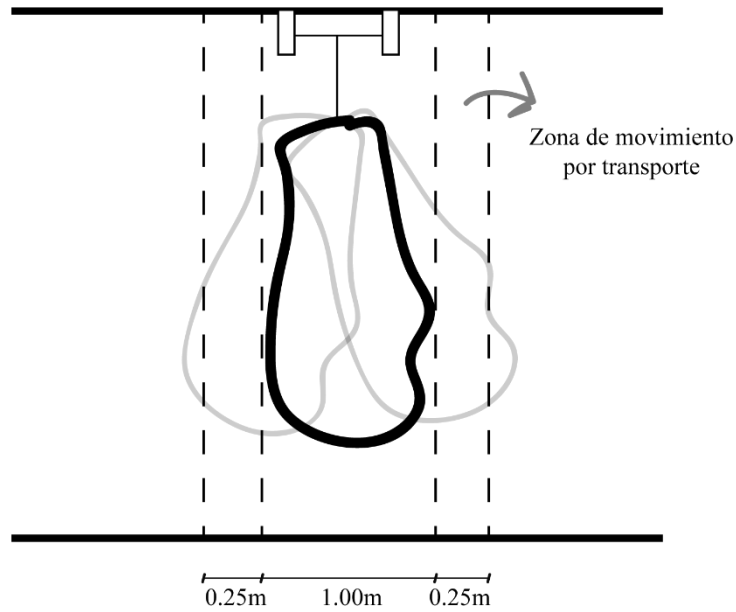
Sección dimensiones de banda de transporte de ganado bovino.
